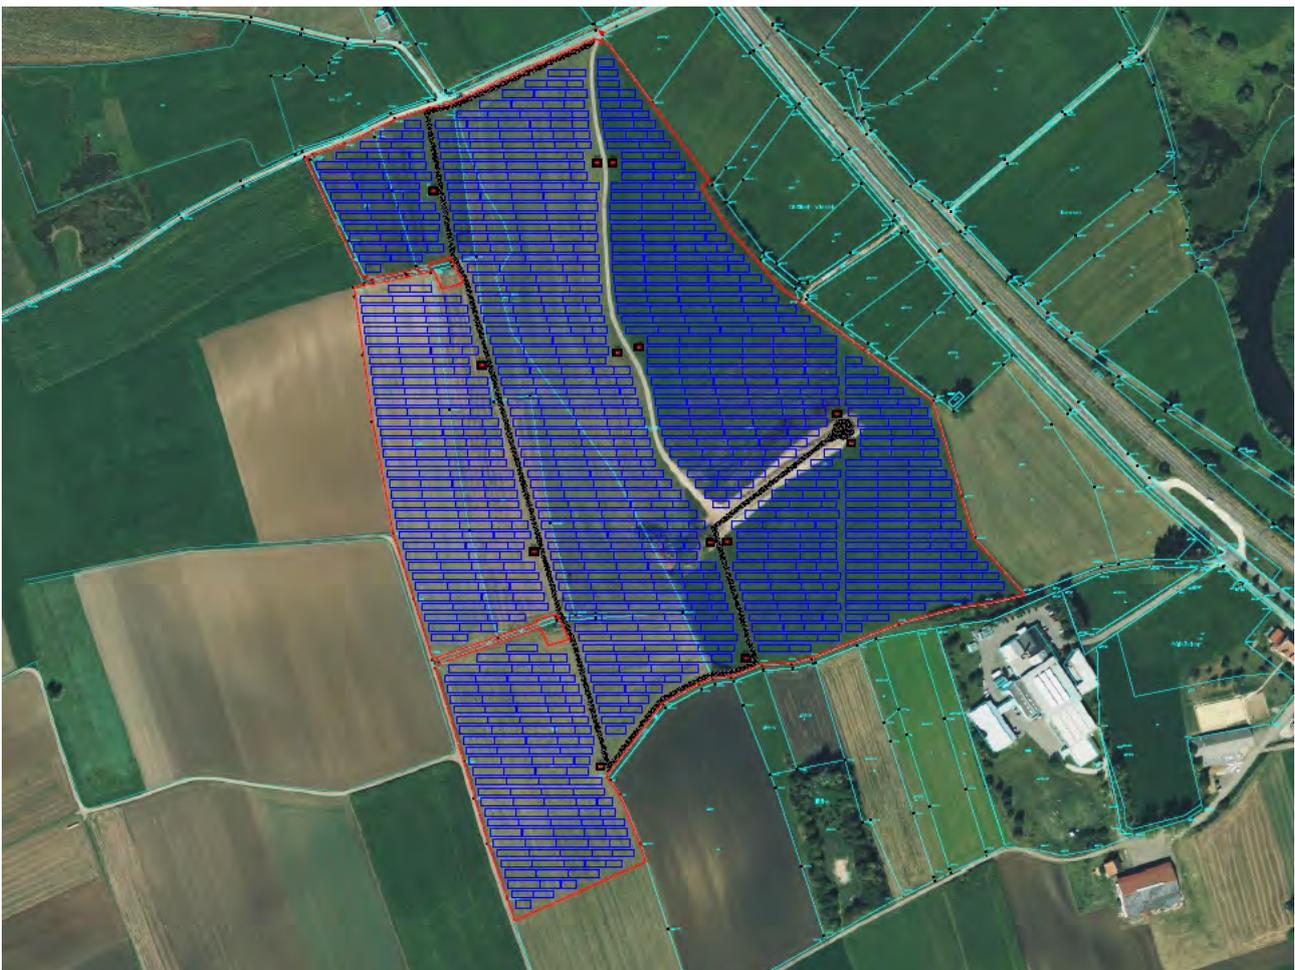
Auszug PVA Neudingen Entwurfsplan, Modullayout, Enerparc AG, Stand 04.04.2023
